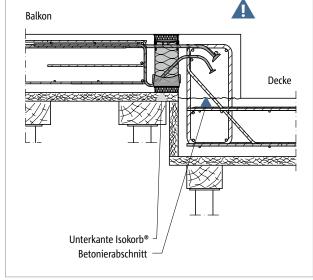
Schöck Isokorb $^{\circ}$ T Typ KL-U: Ortbetonbalkon mit Höhenversatz nach unten
